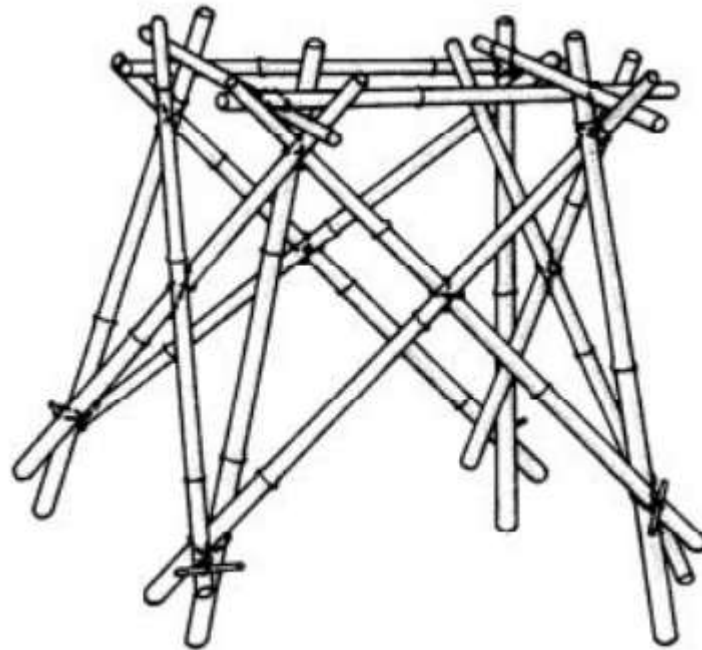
Esquema da estrutura de uma ponte Pylon [10]
